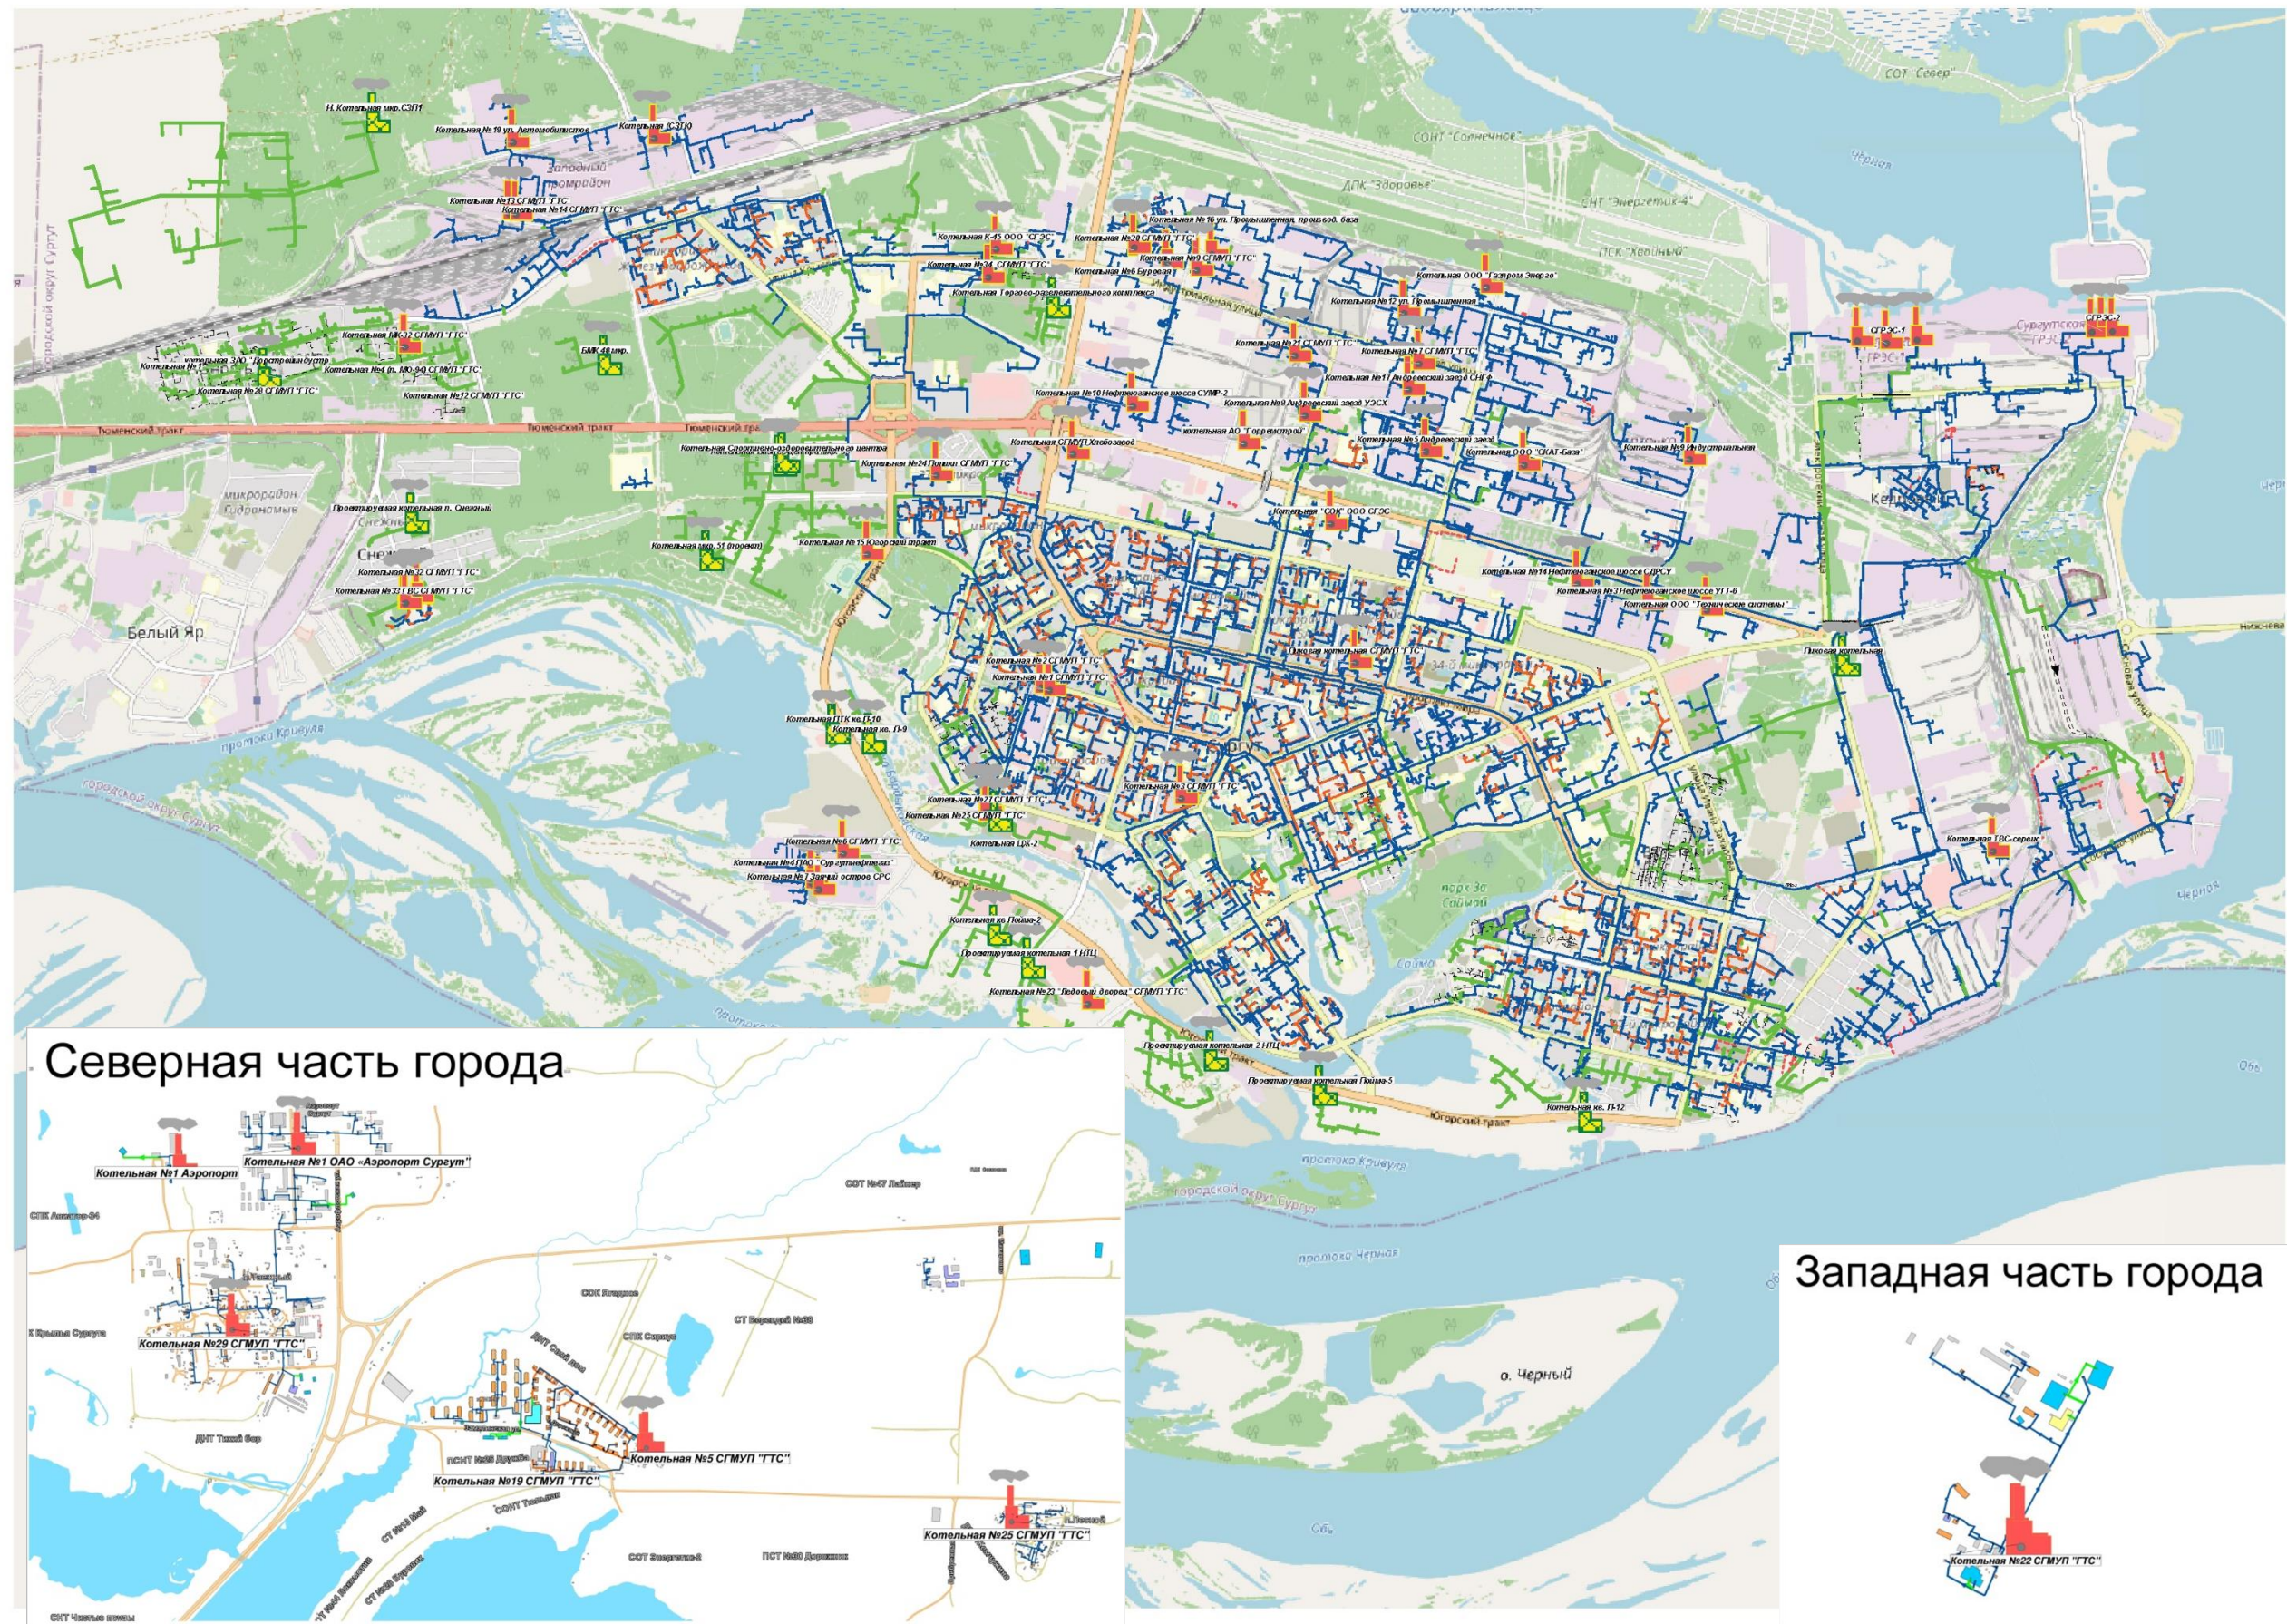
План-схема развития систем теплоснабжения по варианту №2
